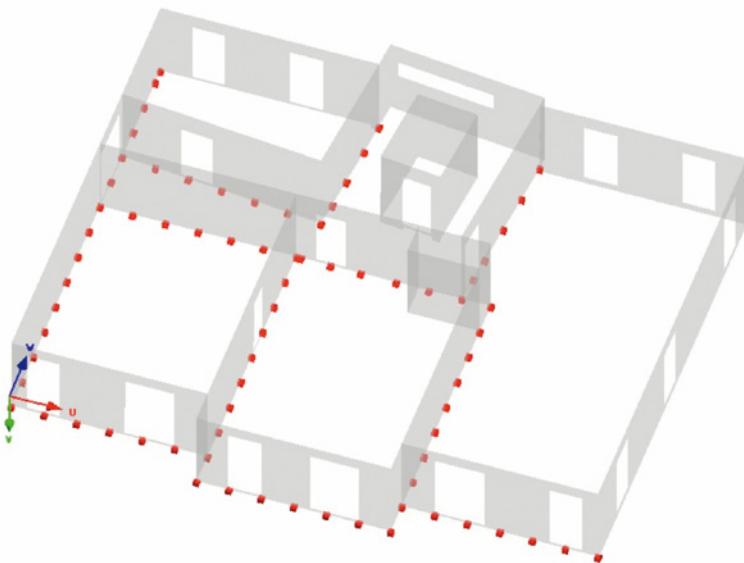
Modell der Stahlbetonhöcker [Werkraum ZT GmbH]
